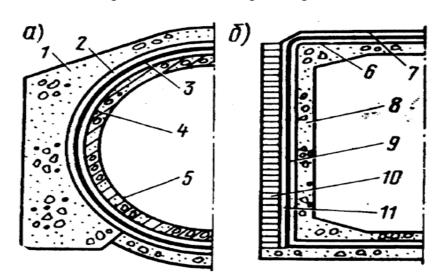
Схема устройства оклеечной гидроизоляции: a — внутренней; δ — наружной
